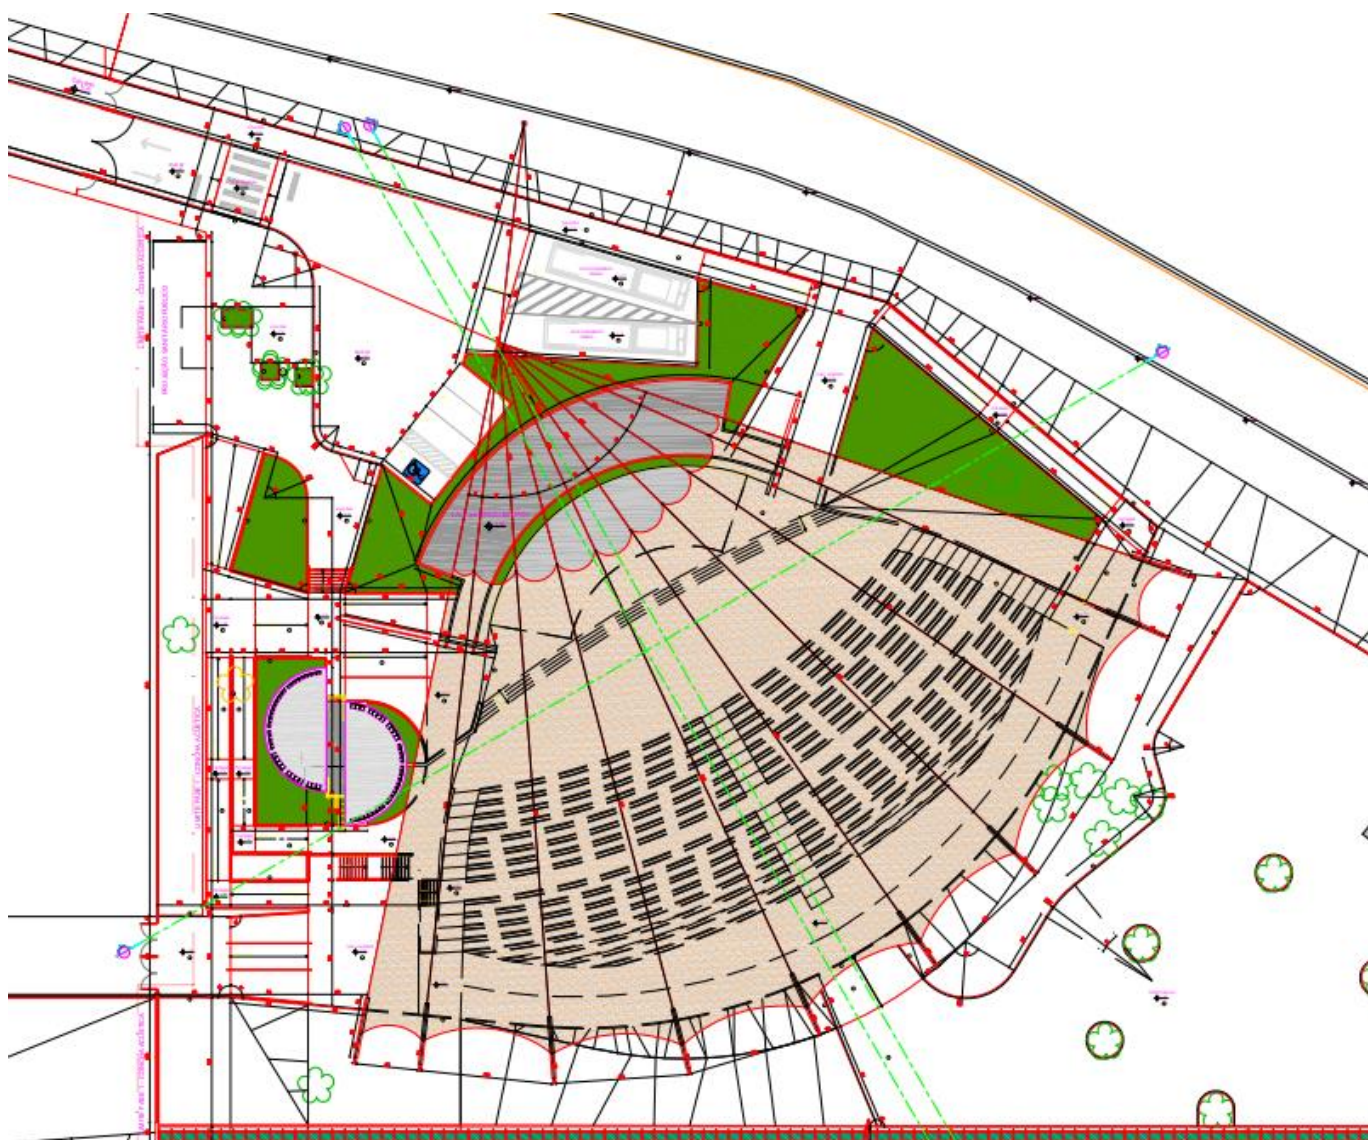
Planta de cobertura da Concha Acústica e Edificações do entorno
